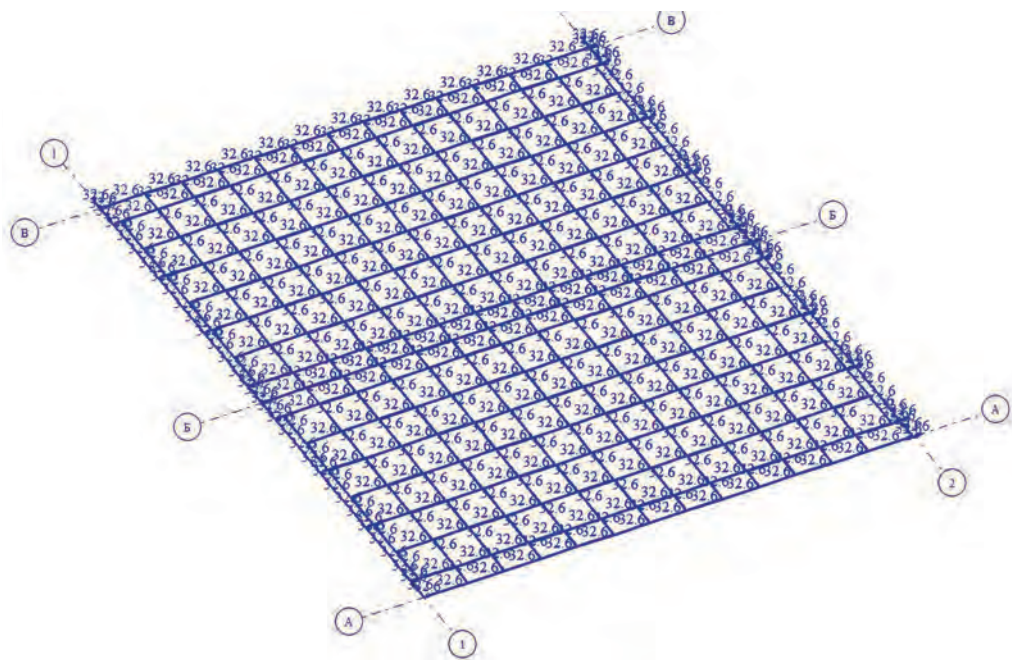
Фрагмент перекрытия типового этажа с температурной нагрузкой в теплое время года.
